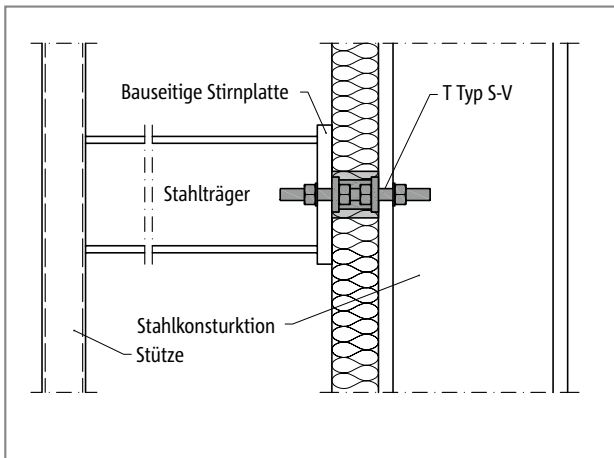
Schöck Isokorb® T Typ S-V: Stahlkonstruktion gestützt
